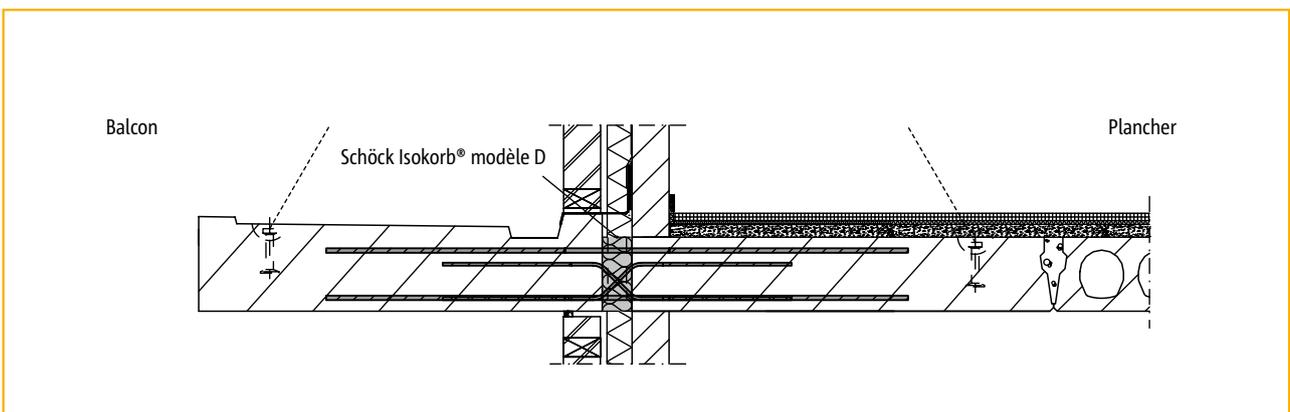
Liaison rupteur Schöck Isokorb® modèle D : balcon préfabriqué et plancher préfabriqué
